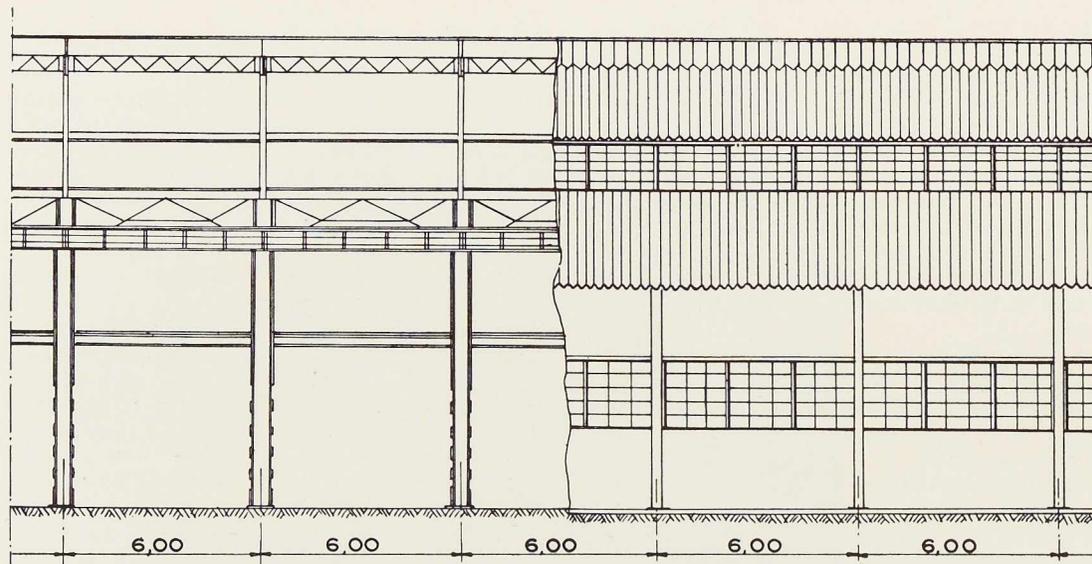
Coupe longitudinale et élévation du nouveau bâtiment.
